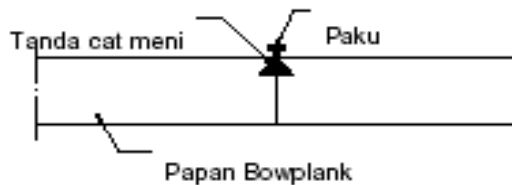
Konstruksi Sambungan Papan Bangunan Diantara Patok
